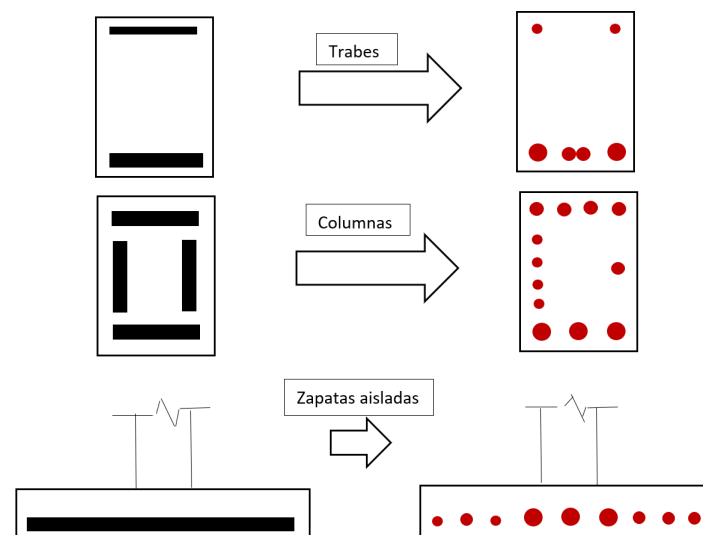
Transformación de ISR a distribución óptima de varillado para elementos estructurales de concreto reforzado tipo: viga, columna y zapata aislada.
